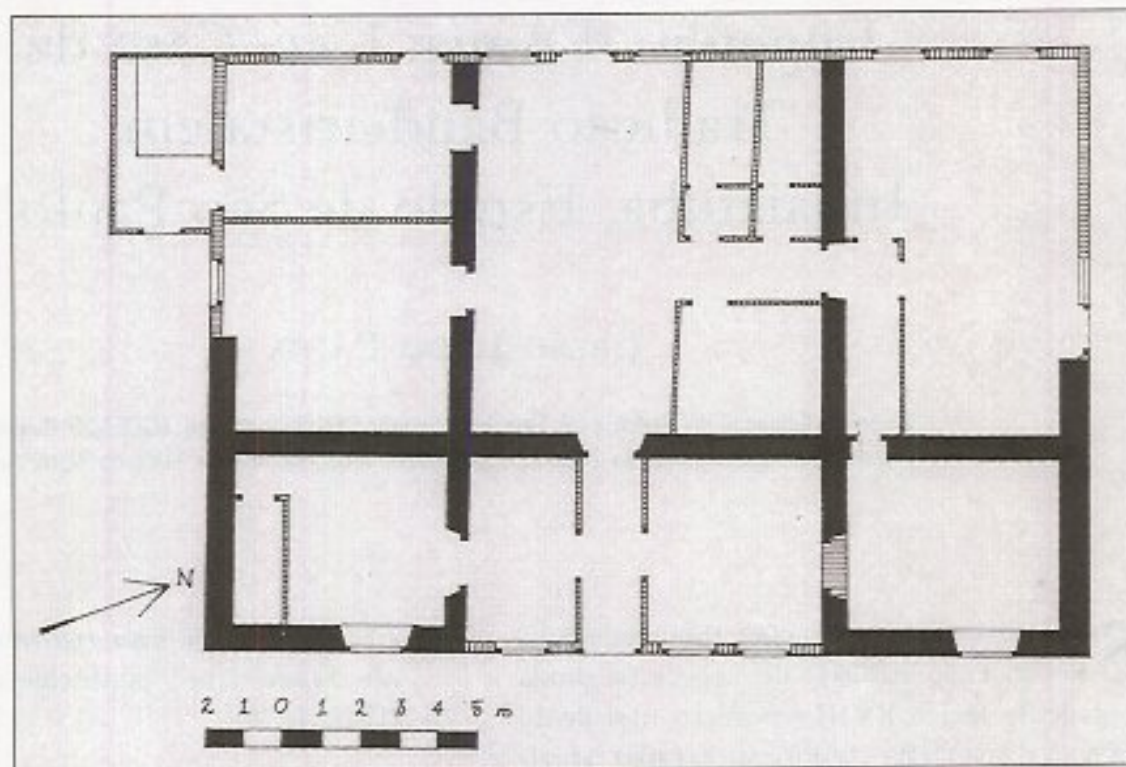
Planta-baixa da sede da antiga Fazenda Engenho d'Água, out. 1995/ mar. 1996. As paredes em preto são de taipa de pilão e as demais de tijolos. Note-se a ligeira assimetria da planta e, na faixa fronteiria, a área do pretório primitivo obturado com parede de tijolos. Desenhado pelo autor, set. 1995/ dez. 1997.
